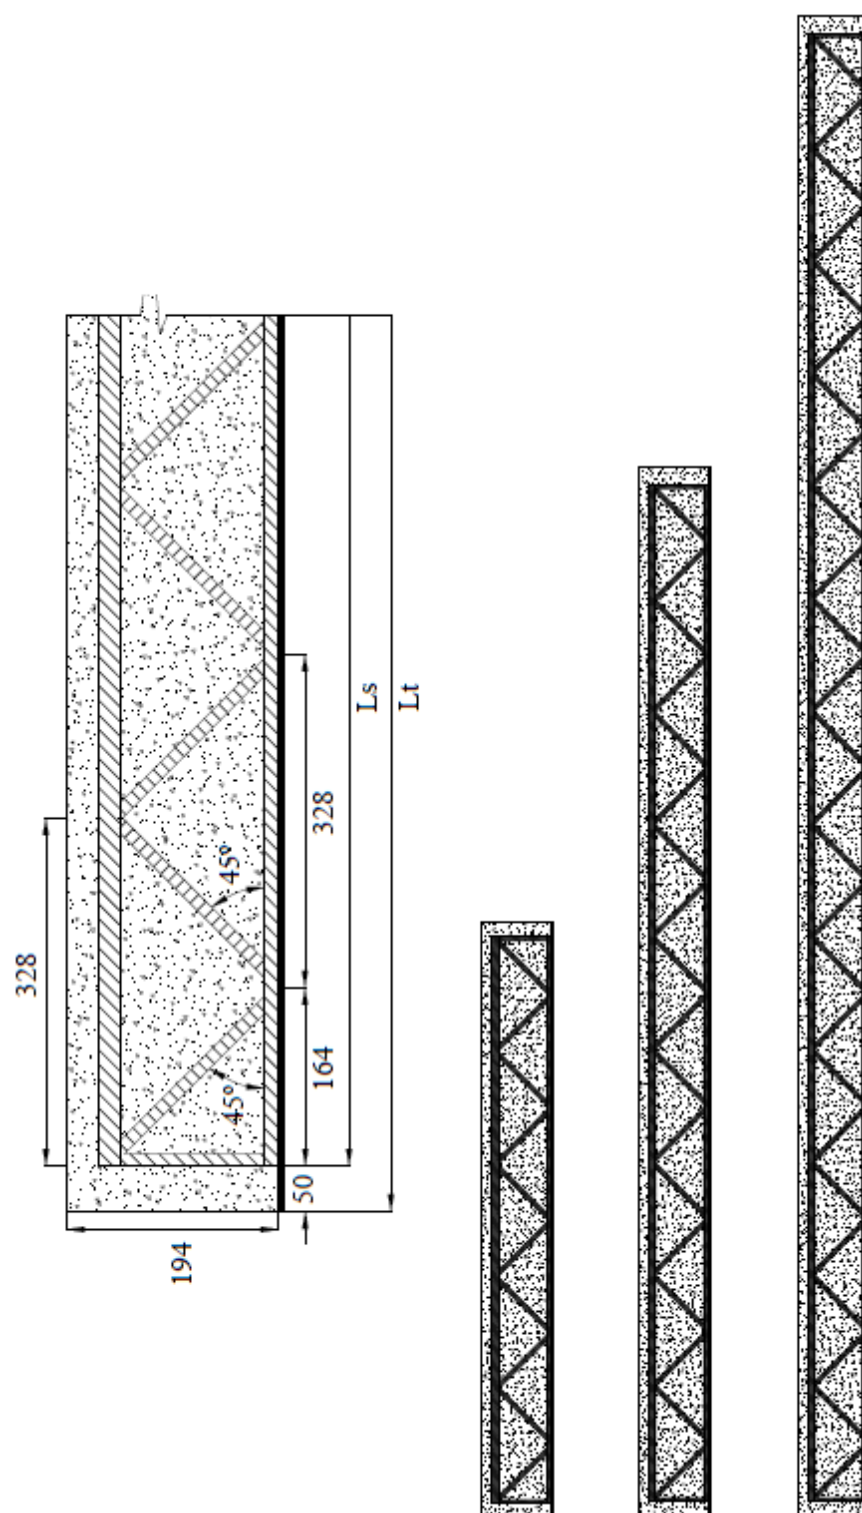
Secciones Longitudinales fase SII, tipo A
